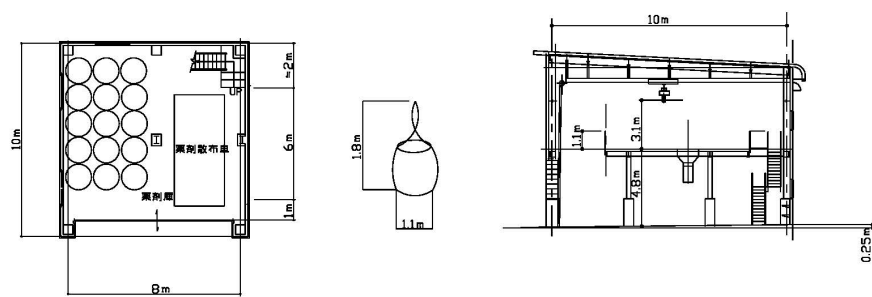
《参考例》単独整備の薬剤庫 平面図及び断面図
